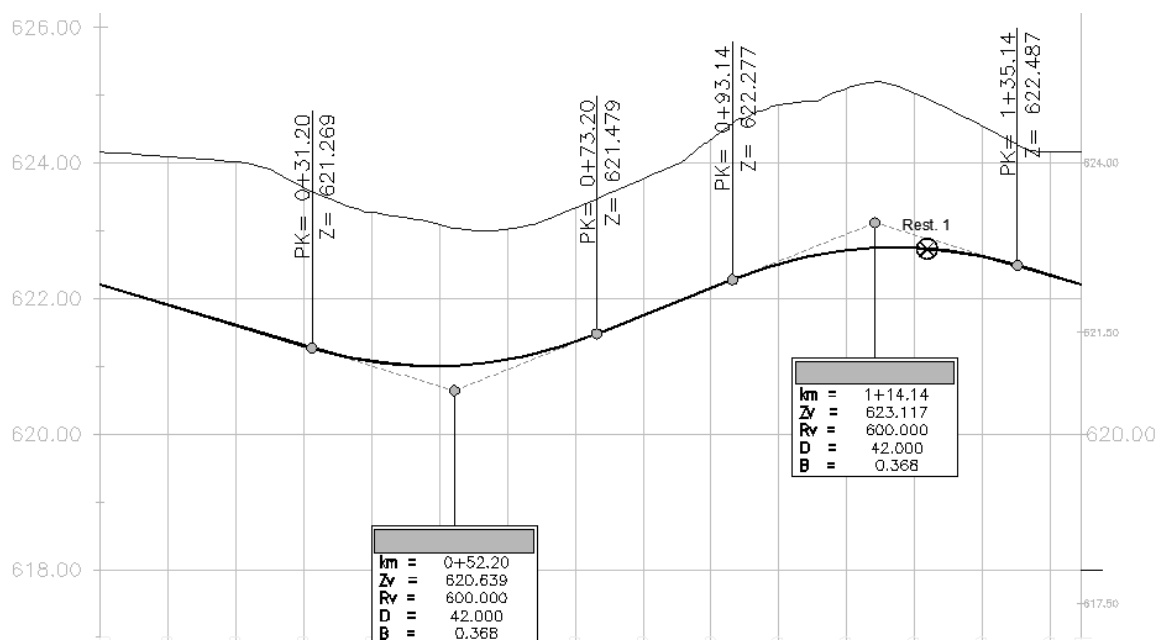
Ponto de intersecção entre Restabelecimento 1 e Rotunda A
